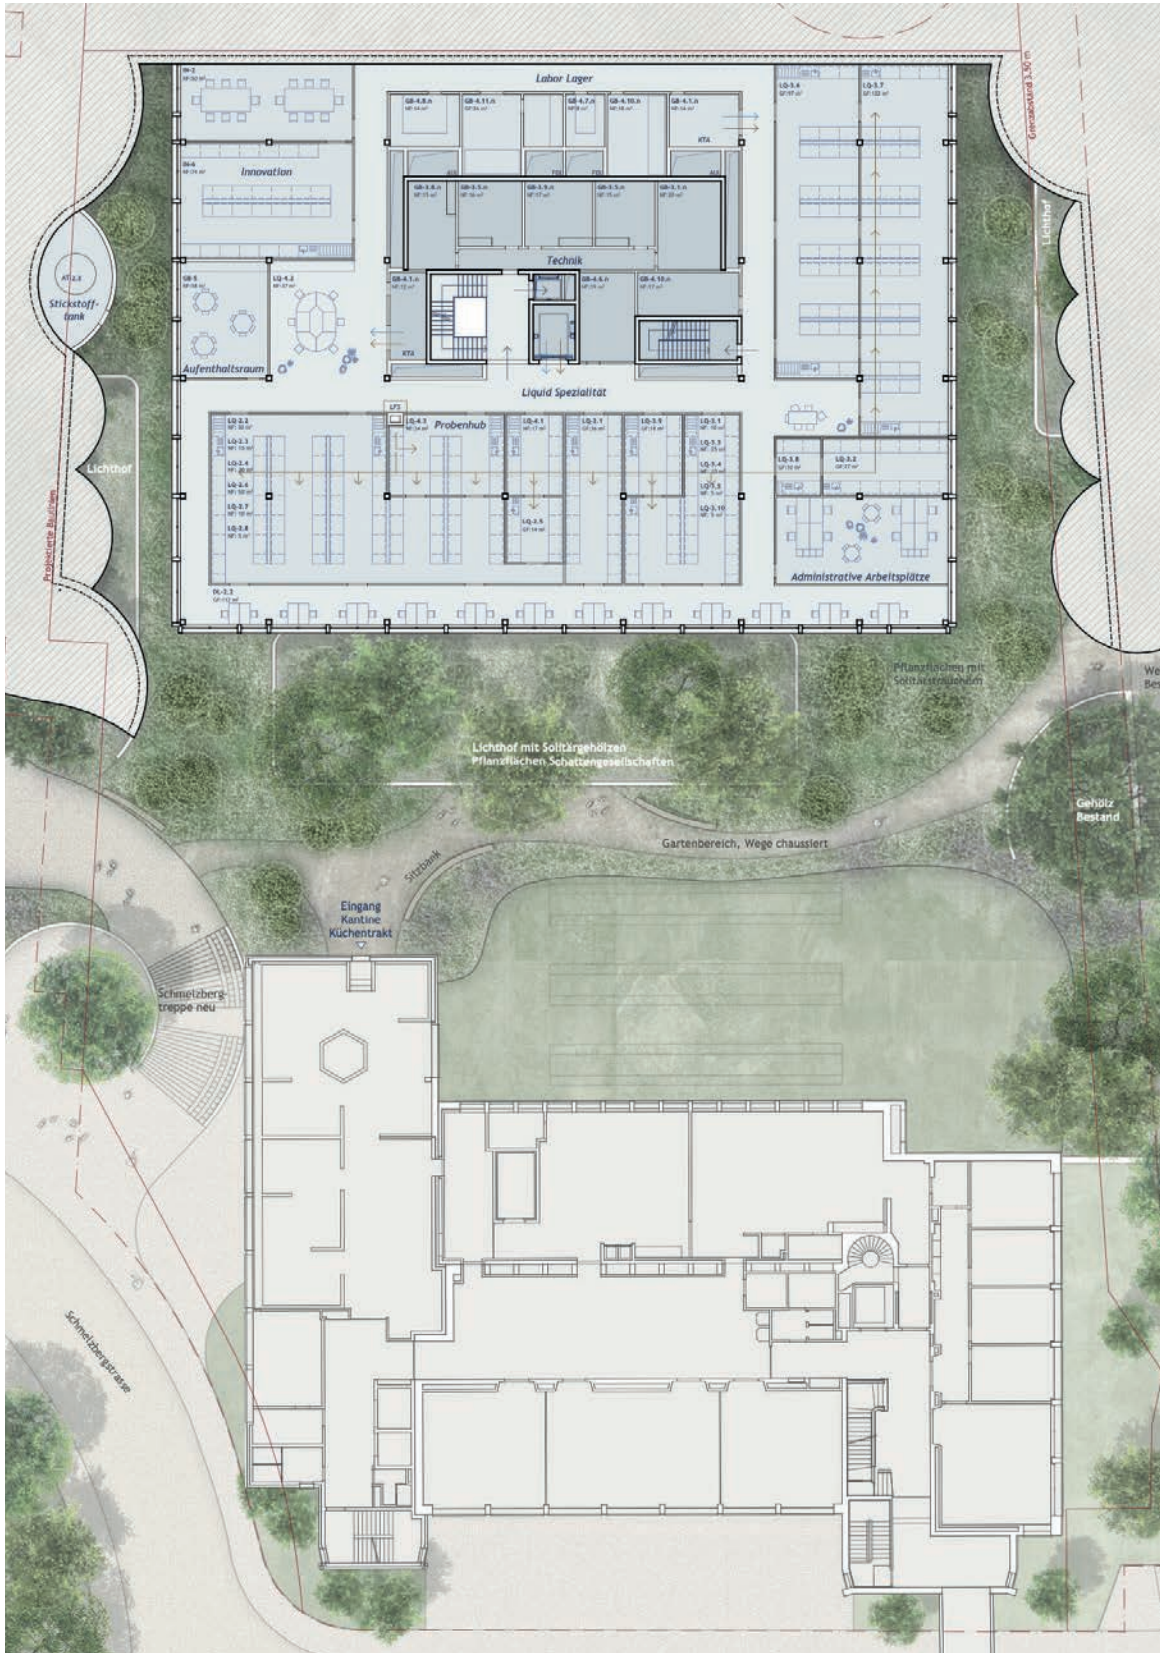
Schneider & Schneider Architekten mit Appert Zwahlen Partner Landschaftsarchitekten: Grundriss 1. Obergeschoss
